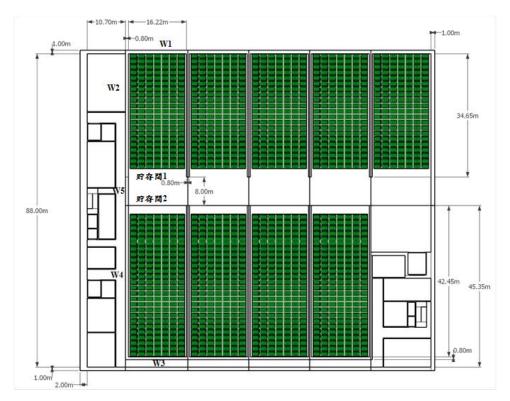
B-25 鋼箱貯存單元平面示意圖
